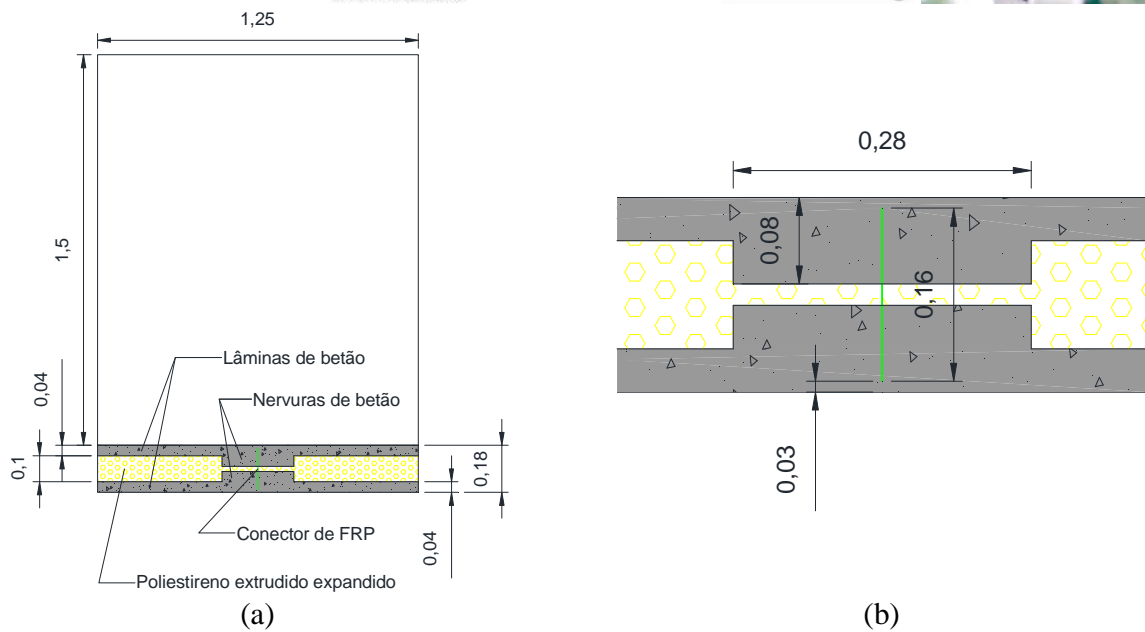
Geometria do painel sandwich com nervuras e conectores treliça de FRP (vista em planta e pormenor; unidades em metros).
